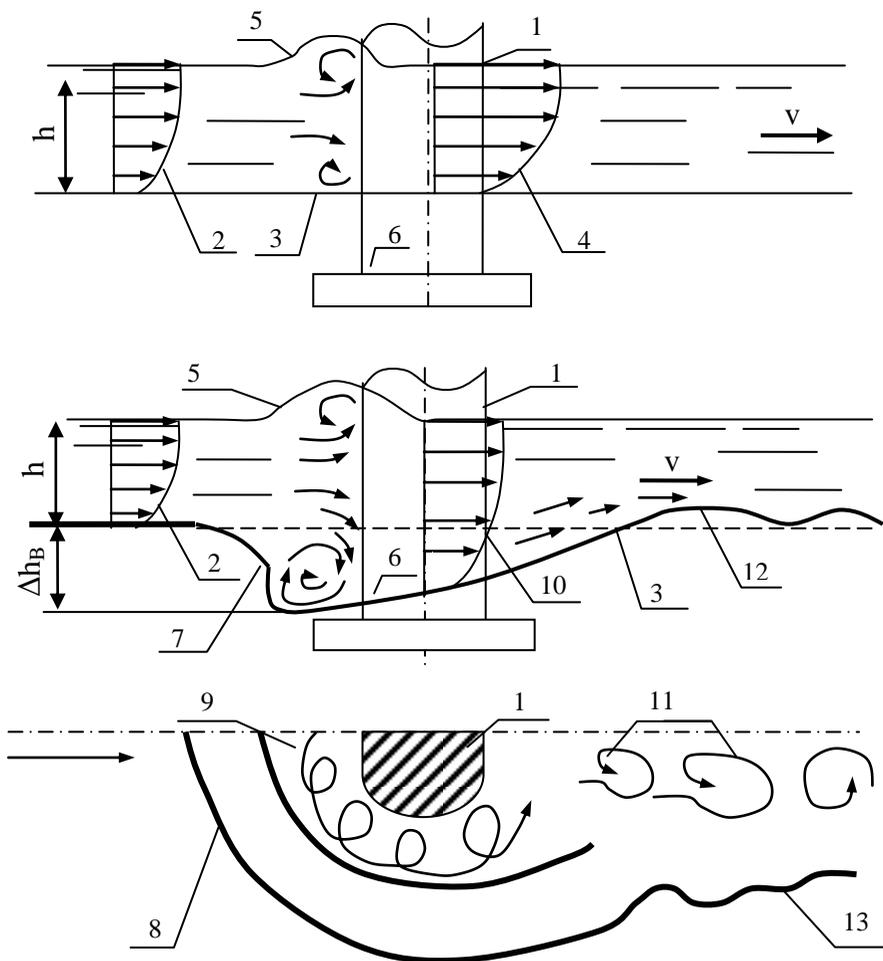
Схема образования воронки размыва около цилиндрической опоры:
